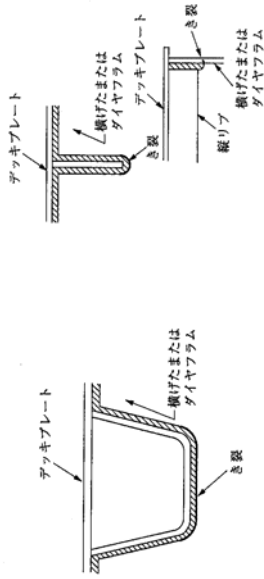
縦リブと端横桁との溶接部の疲労き裂の例
